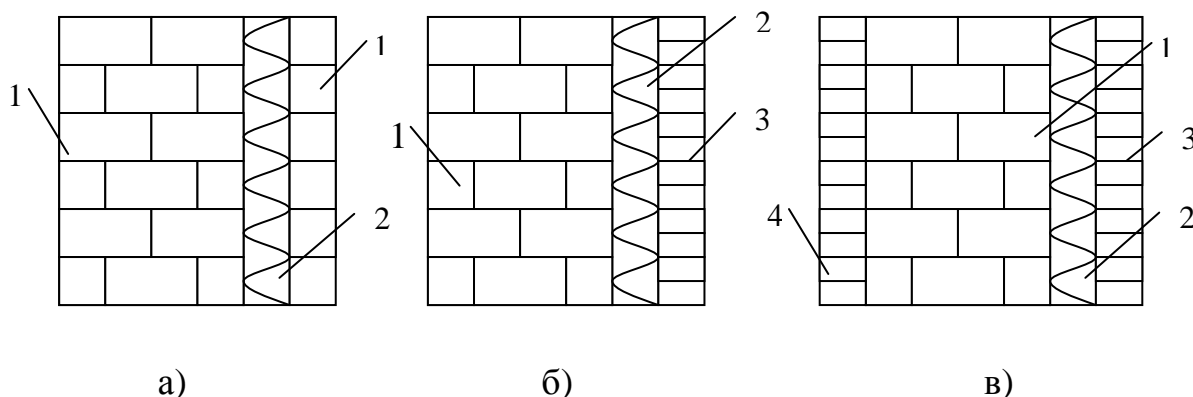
Конструктивные схемы наружных кирпичных стен, где: 1 – кирпичная кладка; 2 – утеплитель; 3 – штукатурка; 4 – гипсокартон
